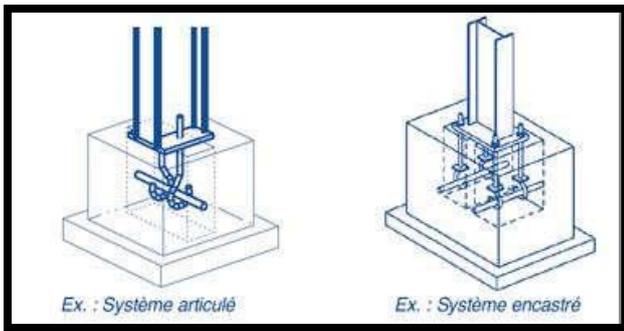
Exemple de poteau métallique avec fondation en béton armé.
